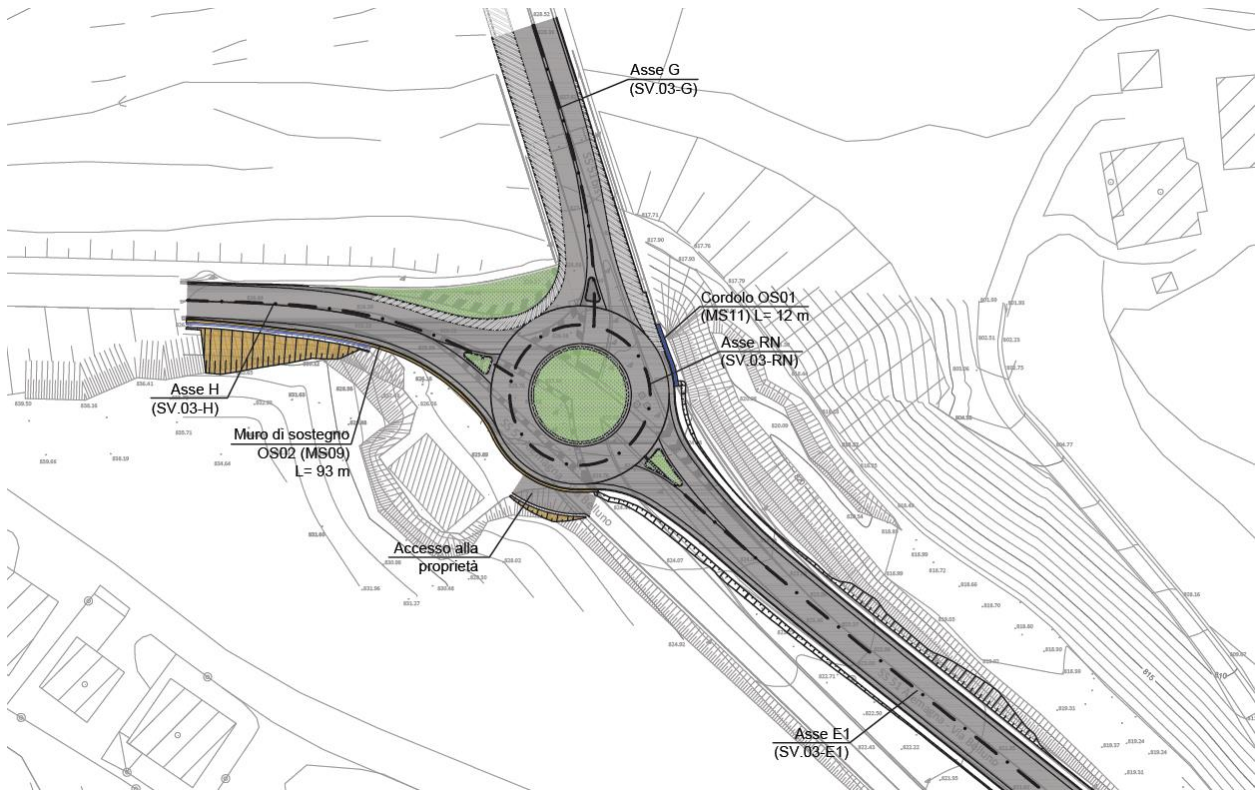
Stralcio planimetrico rotonda svincolo Nord
